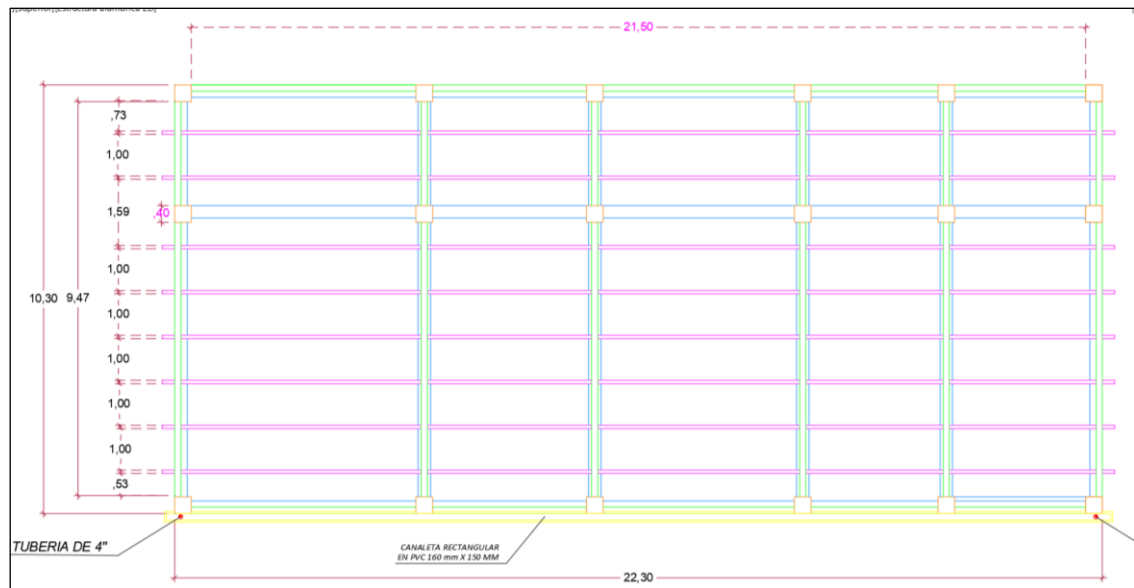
Vista en planta de entramado de perfil de acero, de la estructura 3 del Centro de Desarrollo Infantil.
